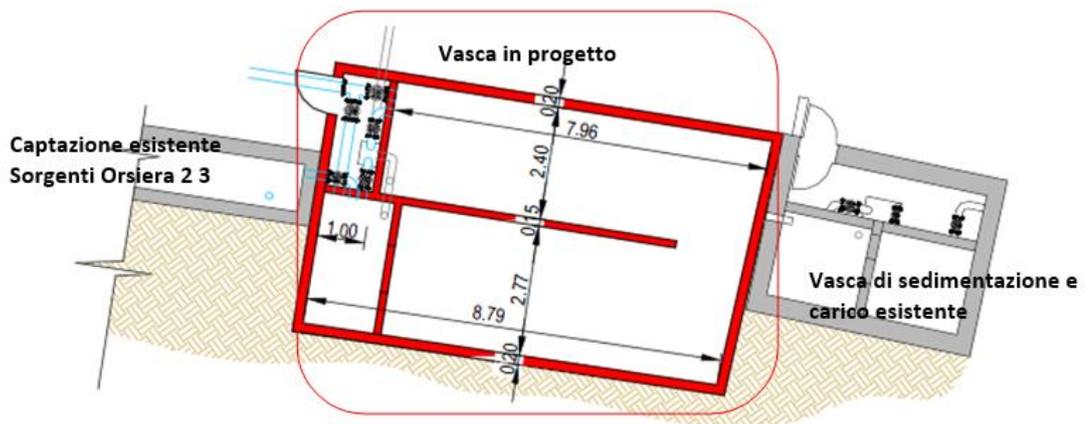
Planimetria vasca in progetto. (Allegato 2)
